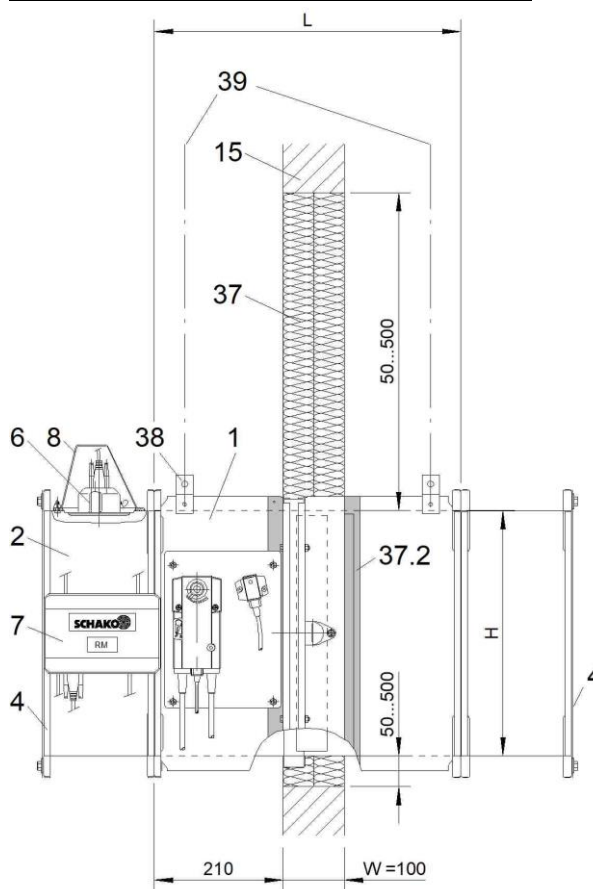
Installation dans un mur massif (épaisseur du mur = 100 mm)
